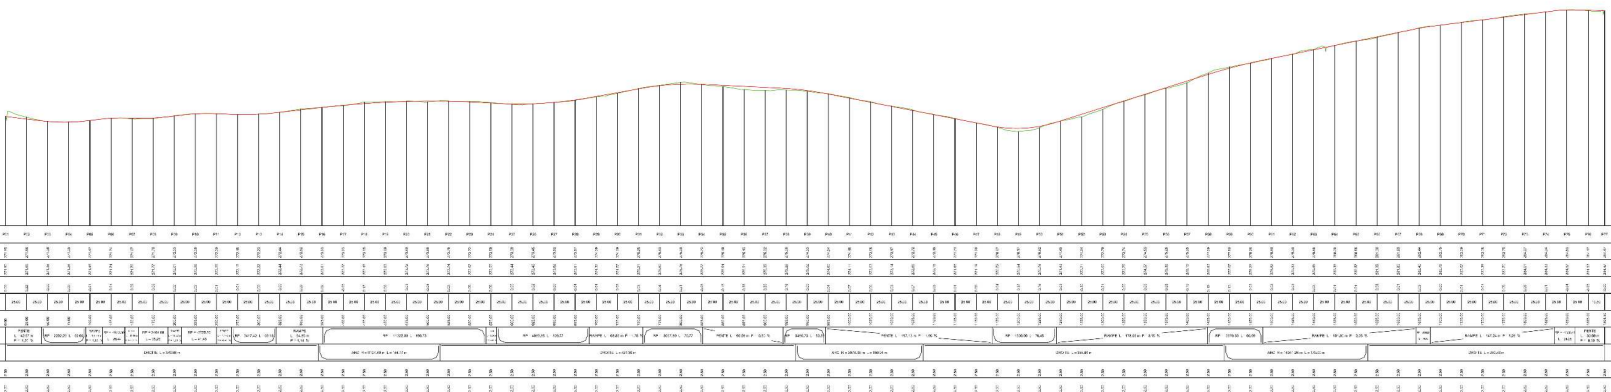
Berneuil, créneau en place élargissement de part et d'autre, profil en long
